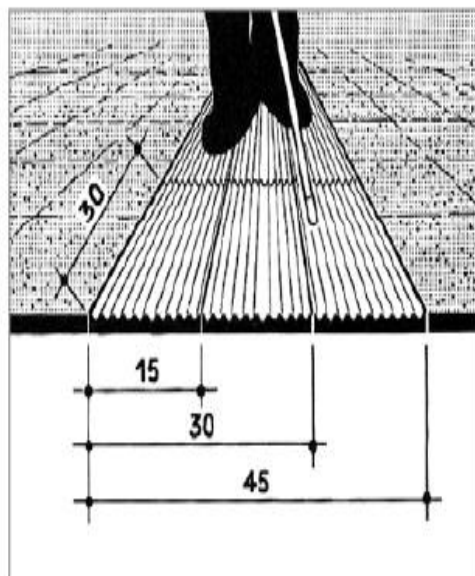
Disposición del pavimento con franjas longitudinales que señala un itinerario.
